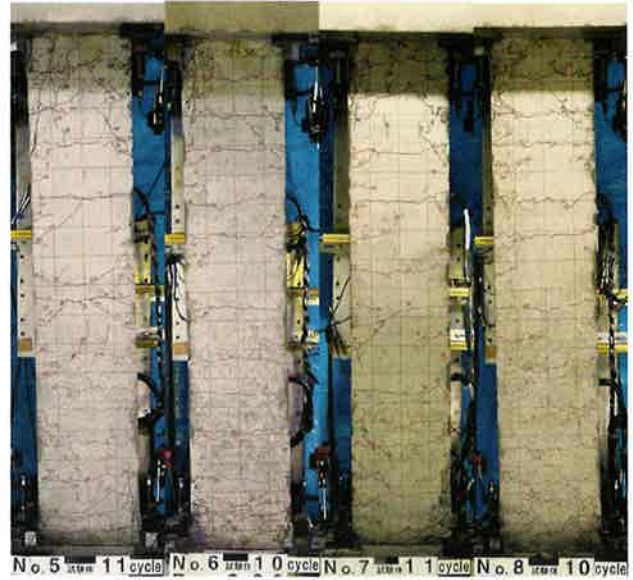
$R=\pm 2.0\%$ 時のひび割れ状況
